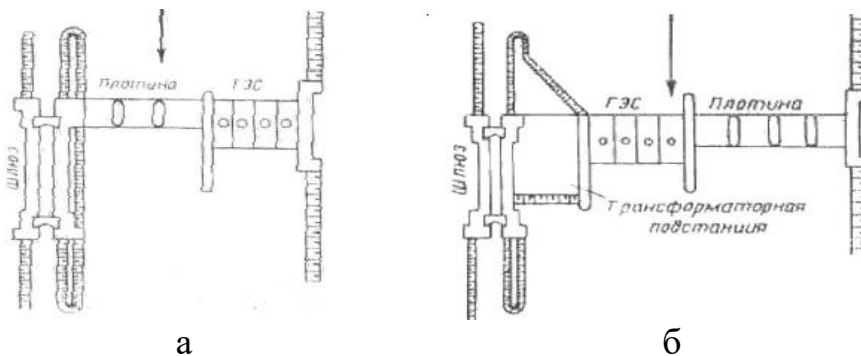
Схеми розташування шлюзу і ГЕС у гідровузлі:
